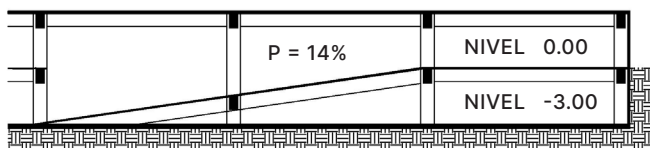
Planta y sección de cálculo de pendiente de rampa.
